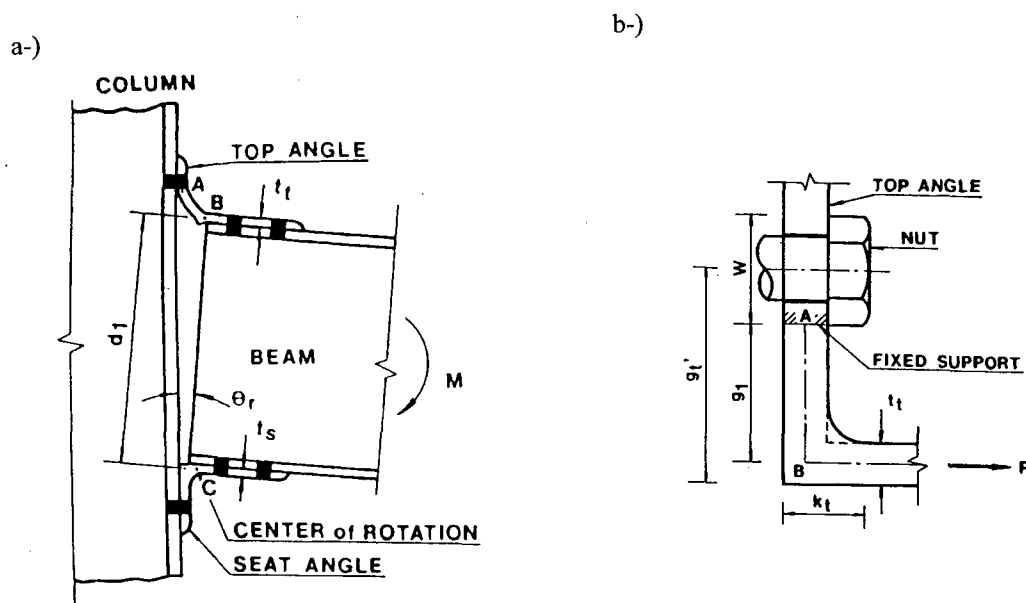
Configuração de deflexão de uma ligação típica “Top and Seat Angles” para a condição elástica e um modelo de viga cantilever para o estado último, retirado de Kirby et al.(1990).
